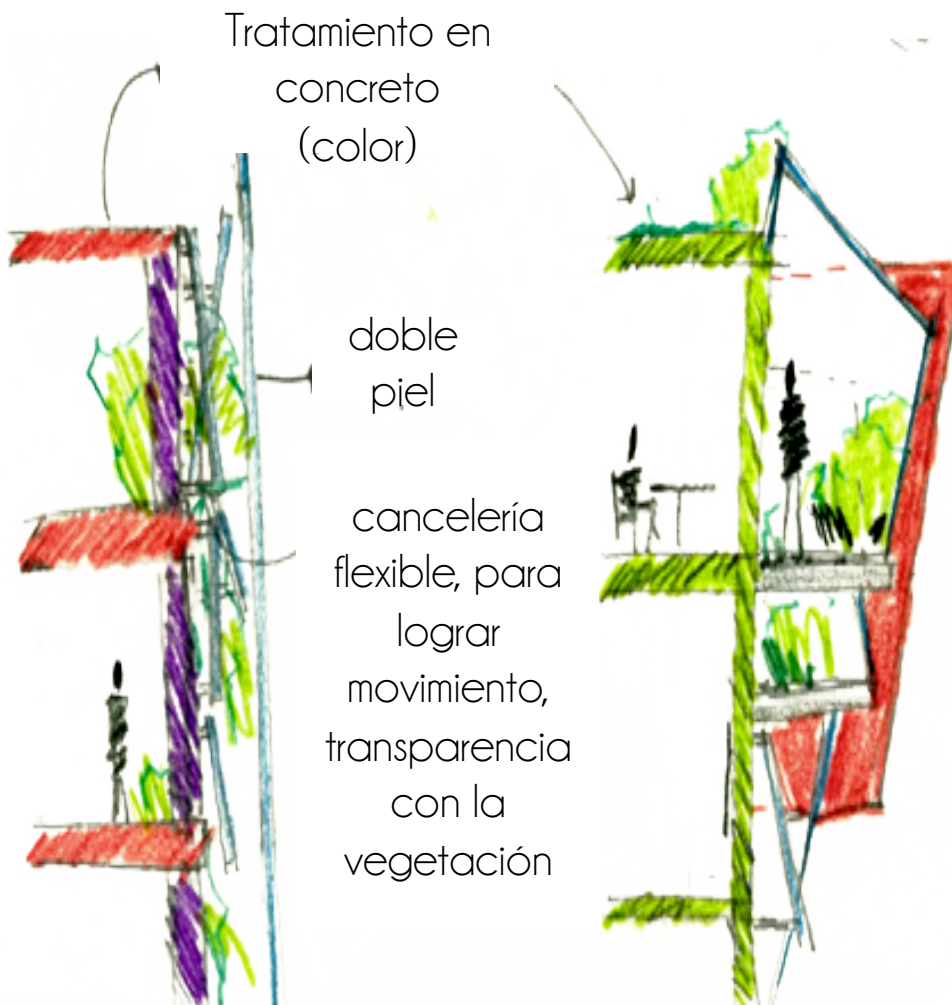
bocetos a mano alzada, de la doble fachada para el edificio2, , Elaboración propia 2011
